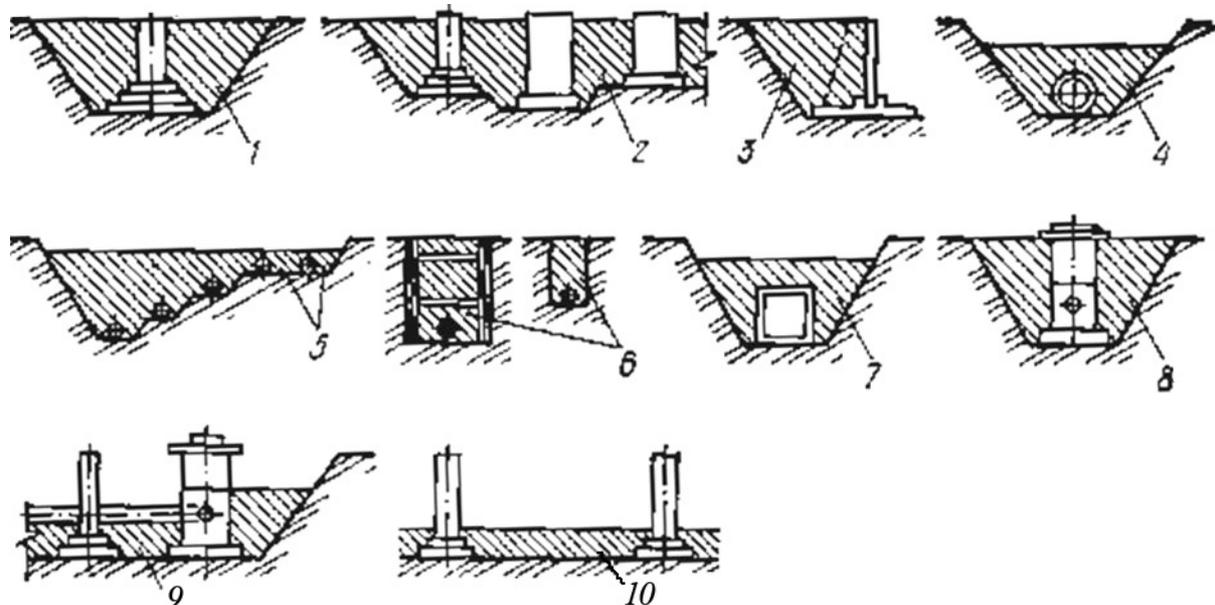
Характерные схемы стесненных мест при обратной засыпке и уплотнения грунтов: 1,2 – пазухи между стенками котлованов и фундаментами под колонны; 3 – то же, между стенками котлованов и подпорными стенками; 4 – то же, между стенками траншей и трубопроводами; 5, 6 – то же, между трубами и стенками траншей; 7,8 – то же, между стенками траншей, коллекторами и смотровыми колодцами; 9 – то же, между трубопроводами; 10 – засыпка грунта под полы внутри зданий
